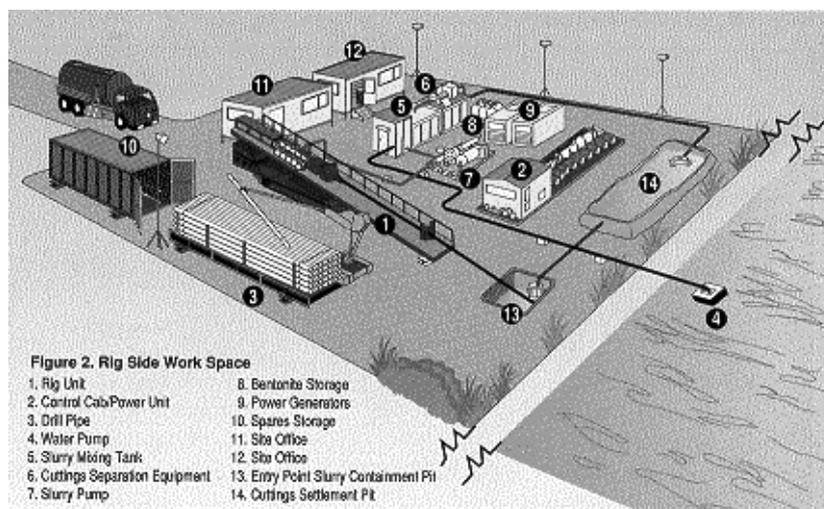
Baustelleneinrichtung am Bohransatzpunkt: Bohrgert und Hilfseinrichtungen [3]
